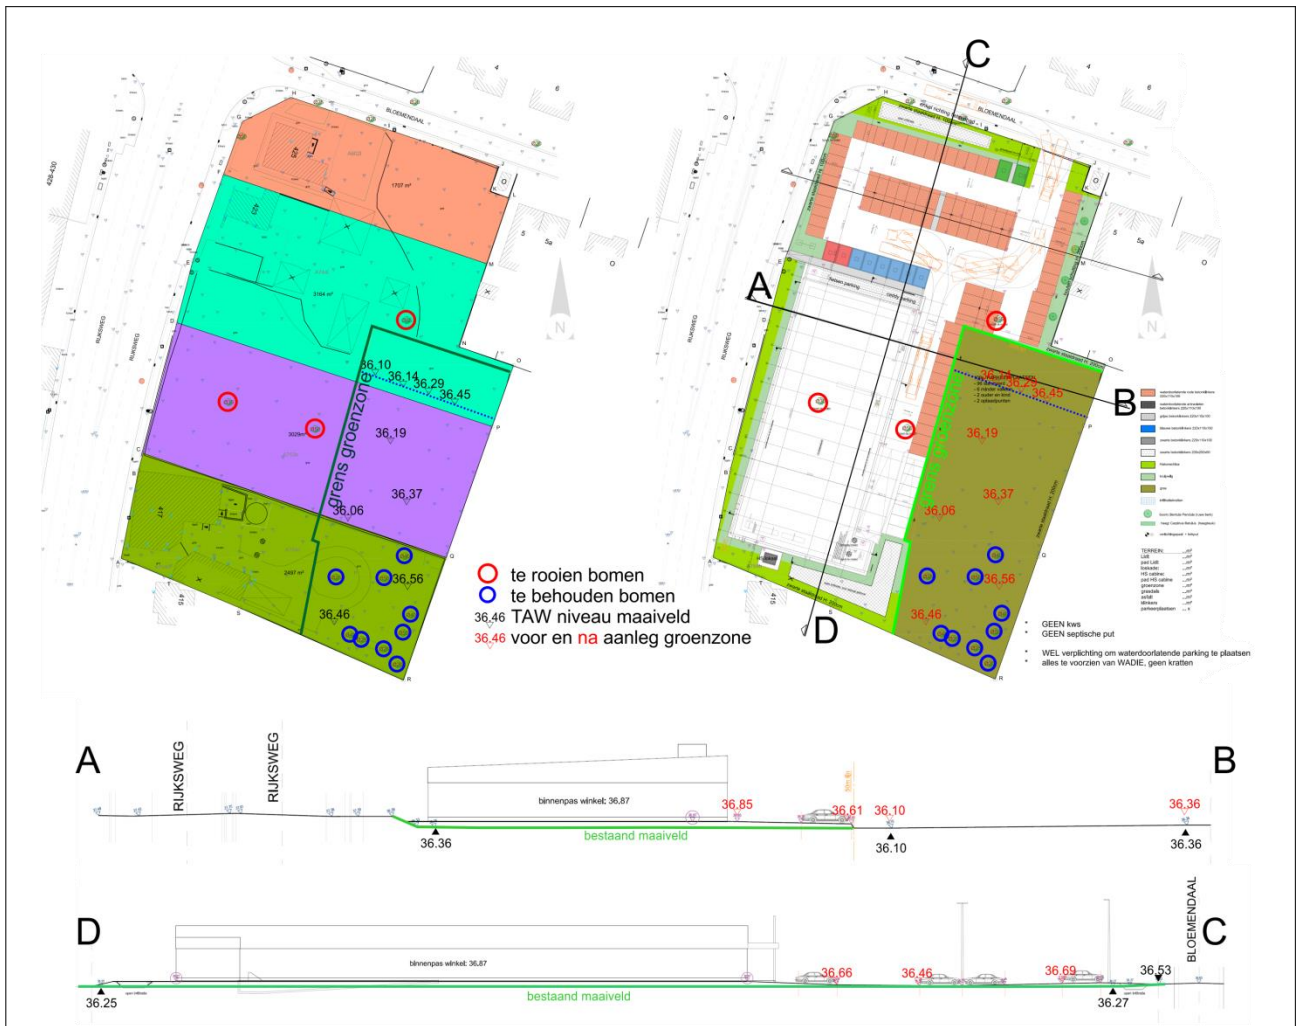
Vergelijking opmetingsplan en nieuwbouwplan met aanduiding van te behouden bomen, groenzone en niveaus van het maaiveld
